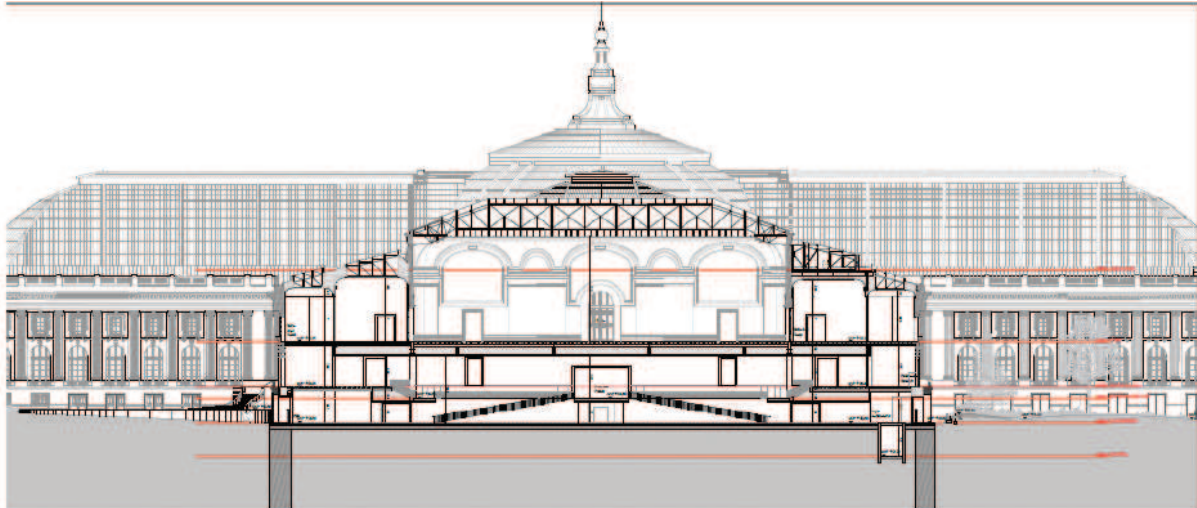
Plan de coupe du Grand Palais, bâtiment intermédiaire (niveau APD). A gauche du plan, le Square Jean Perrin et l'entrée du Grand Palais menant à la Rue des Palais. (c) LAN
